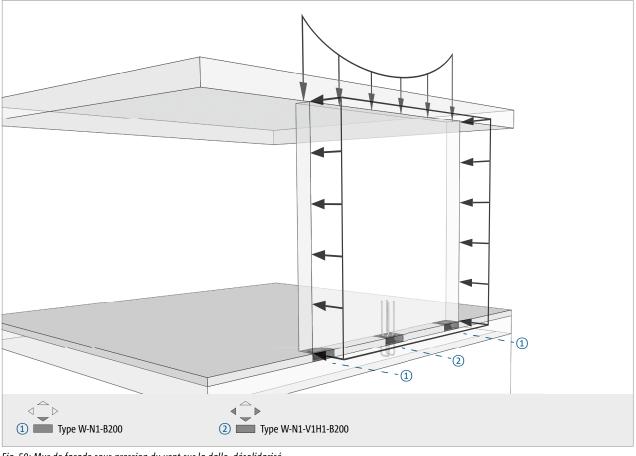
Mur de façade sous pression du vent sur la dalle, désolidarisé
